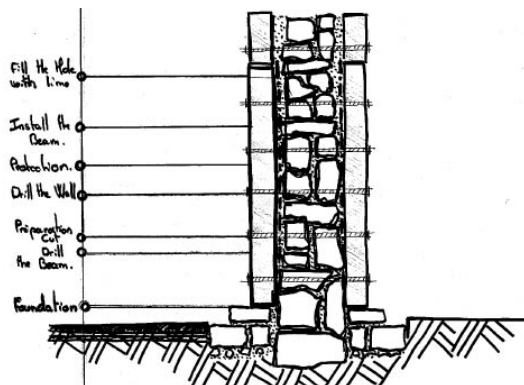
Ancoraggio dei pilastri @CConcrete
